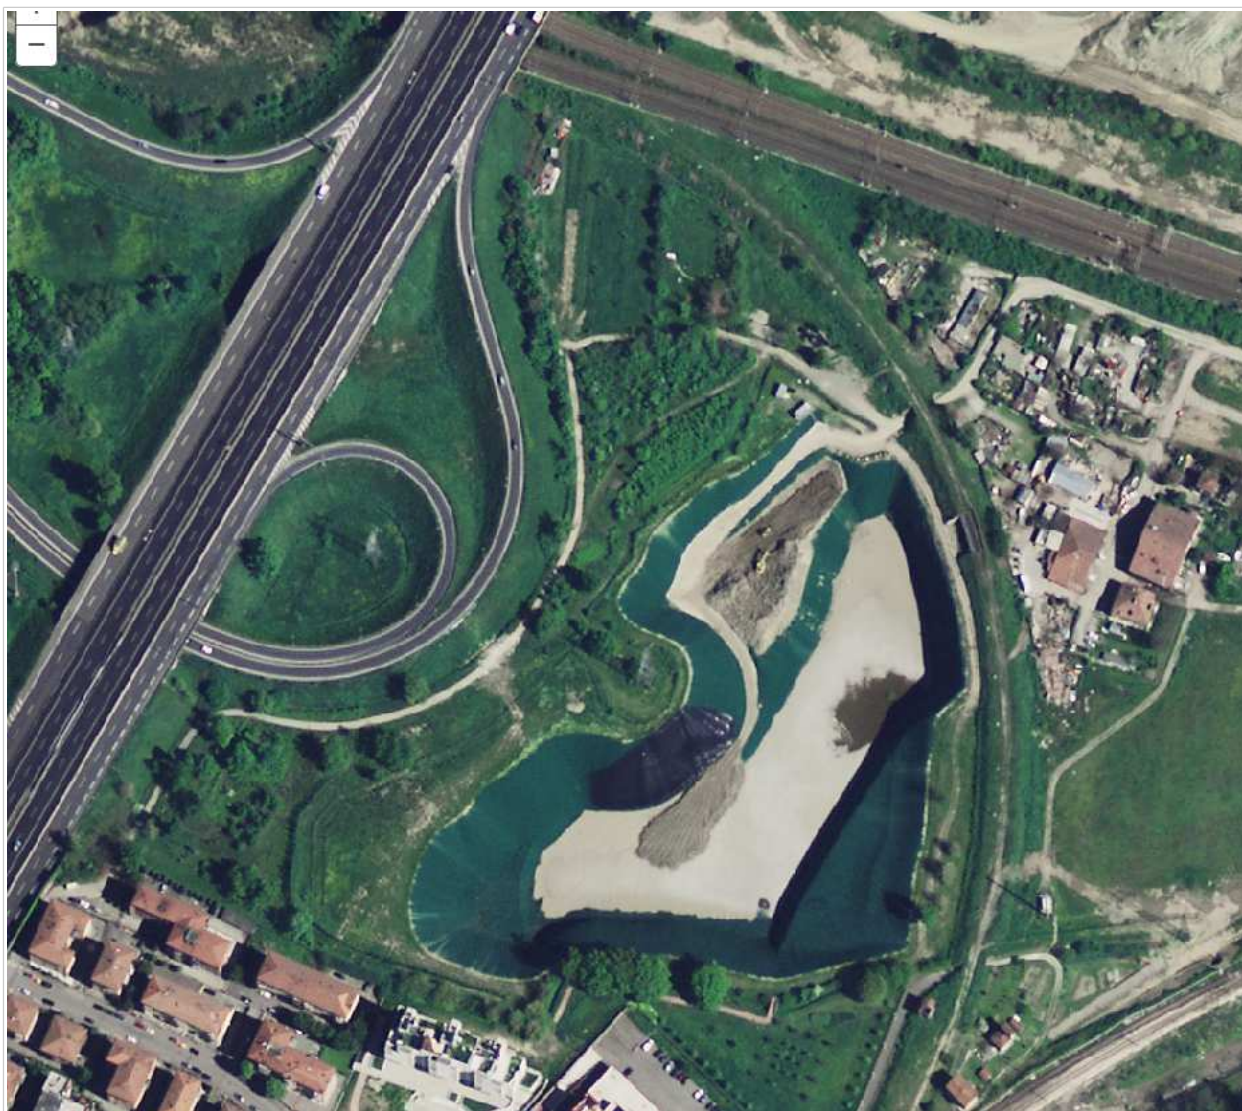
Foto aerea 2005 – Cava Bruschetti con impermeabilizzazione in HPDE.
